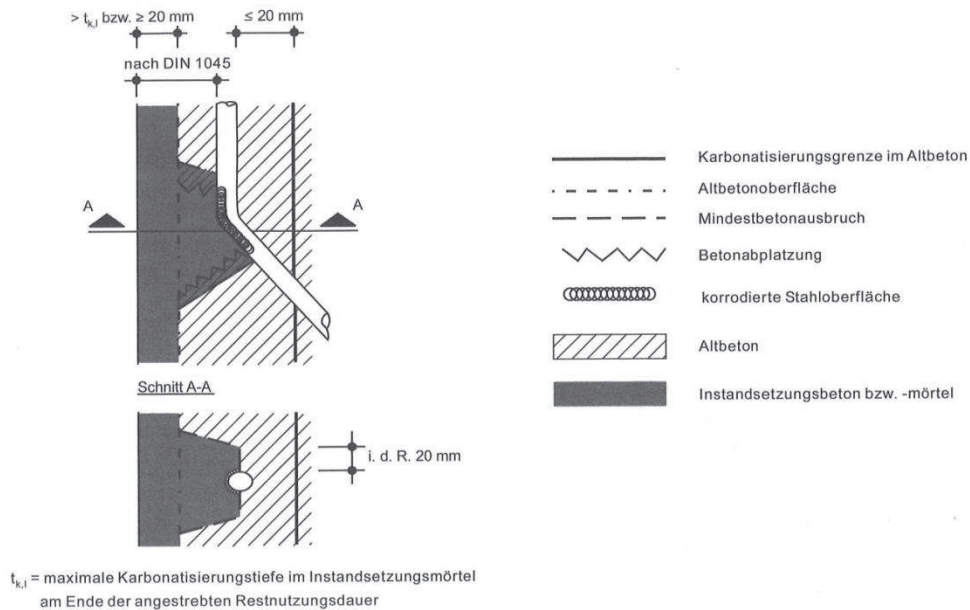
Detailausschnitt Sanierung im Bereich des Balkons "Sürther Rheinterrassen"
